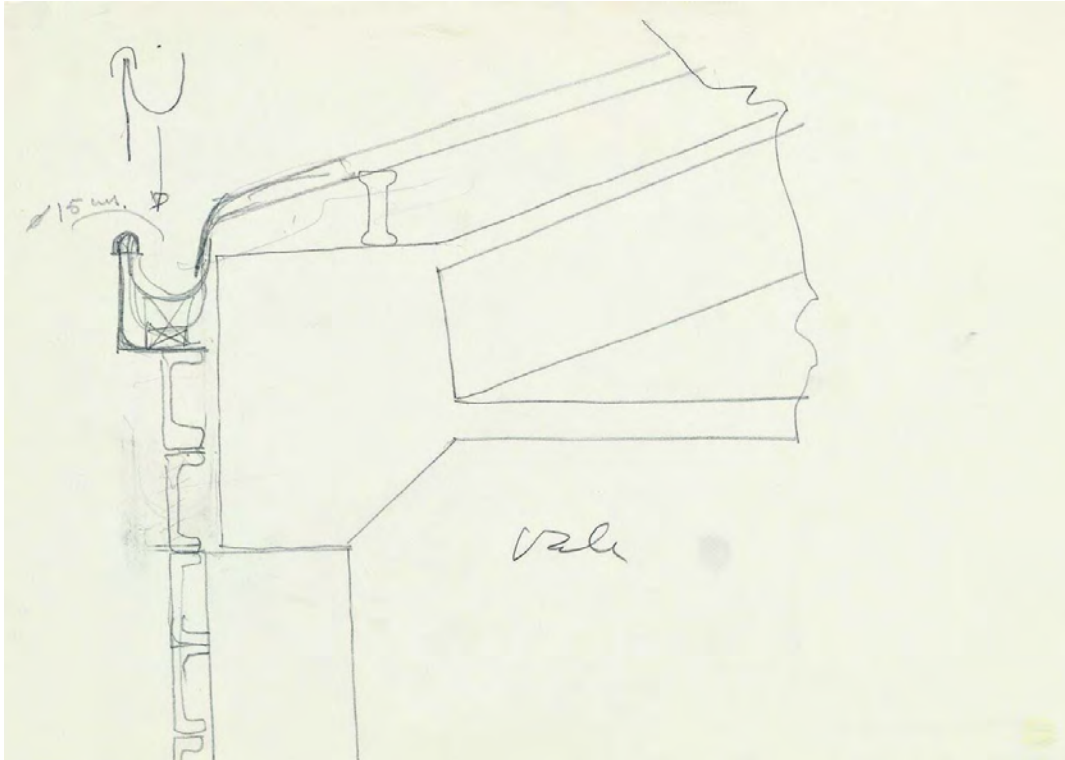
Detalle constructivo con representación de las piezas prefabricadas de recubrimiento de hormigón y su perfil ahuecado en el interior. Fundación A. de la Sota.
